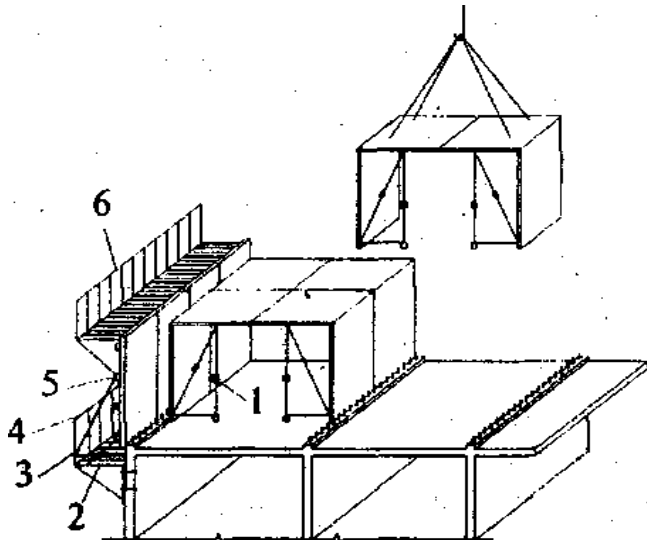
Схема зведення поверху будівлі в об'ємно-переставній опалубці:
